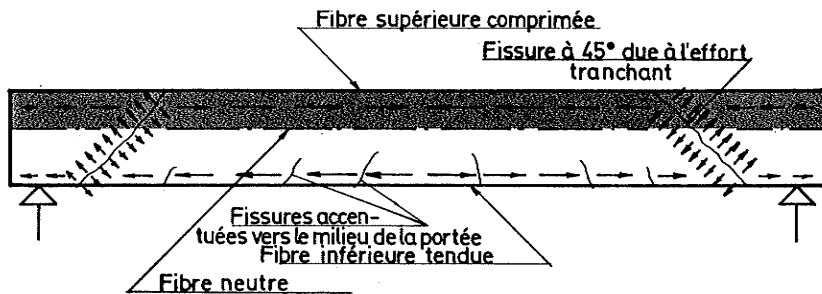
Poutre en béton armé soumise à l'essai de chargement.
